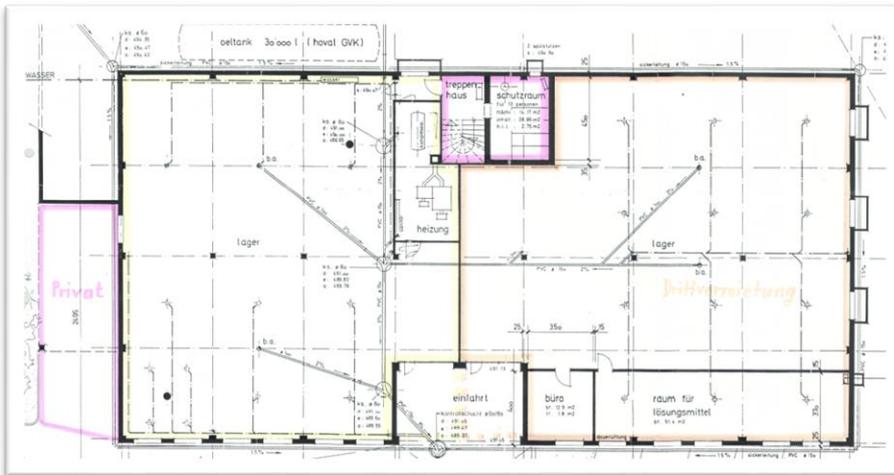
; Grundriss UG Merbag-Gebäude
